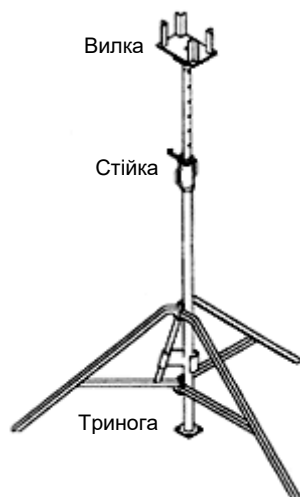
Телескопічна стійка для опалубки перекриттів
